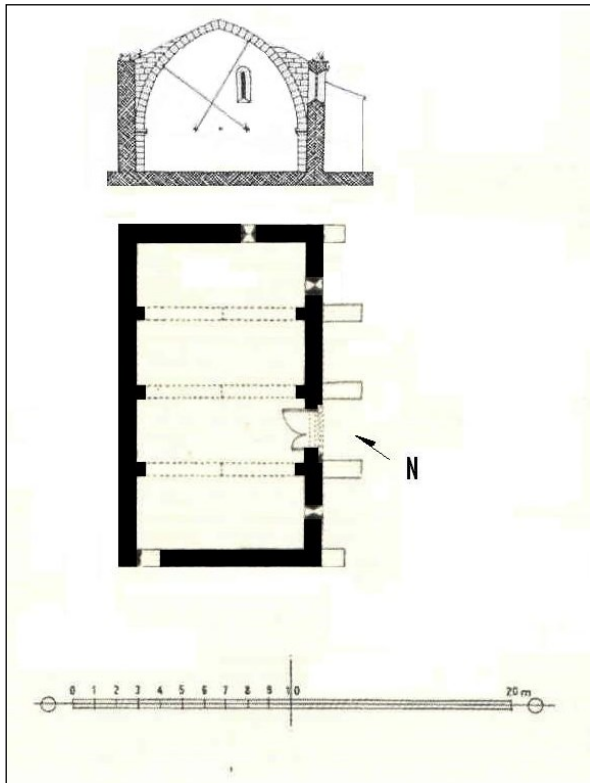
Planta y alzado de Santa Lucía de Salvaroria según Arturo Zaragoza.
